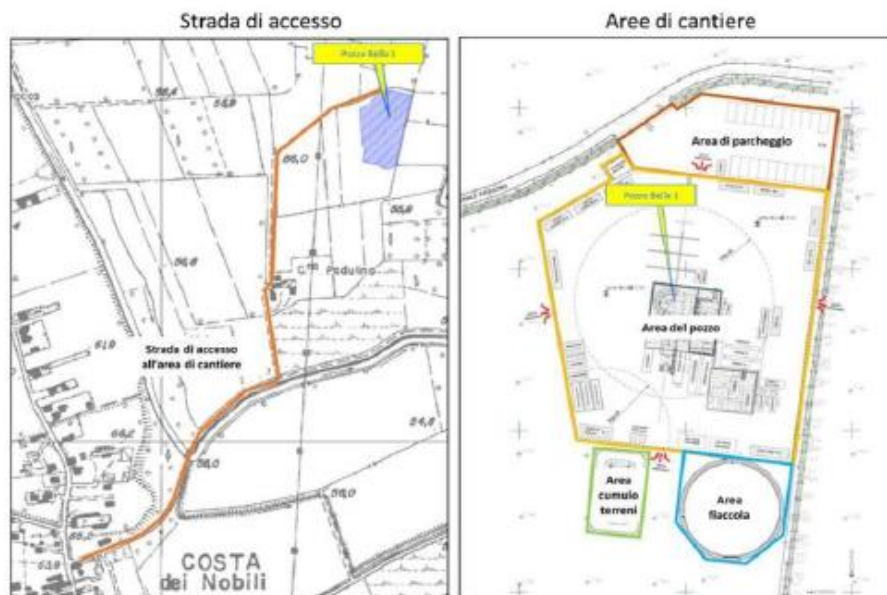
Localizzazione della strada di accesso e delle aree di cantiere
